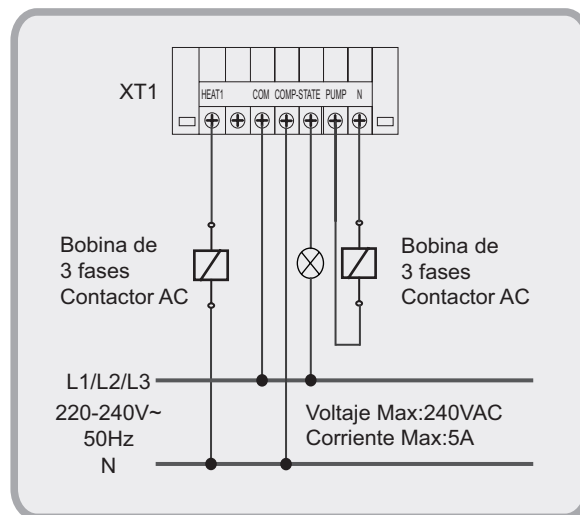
Cableado de la bomba de agua, del calentador auxiliar de las tuberías y de la luz de CA de estado del compresor
